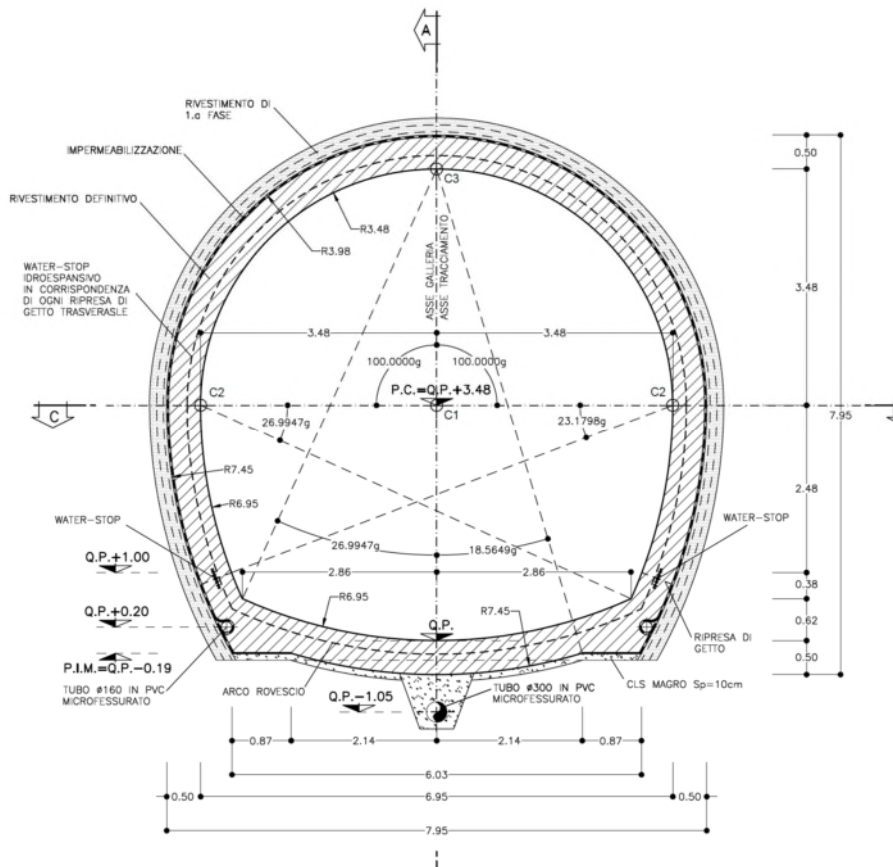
Sezione Tipo Ab – Carpenteria – Sezioni
